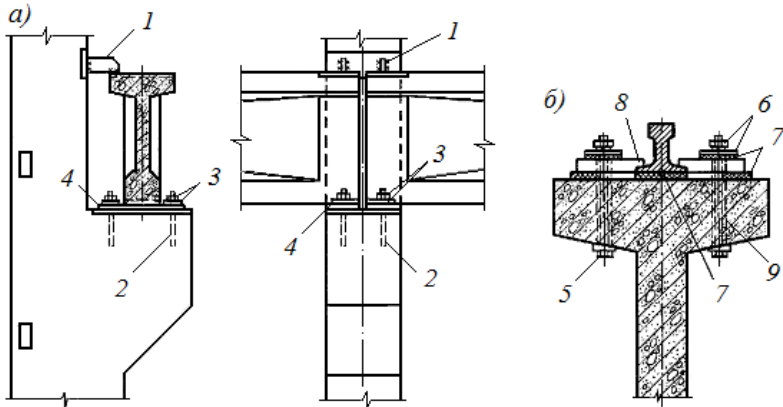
Вузли кріплення залізобетонних підкранових балок: *а* – до колон; *б* – кріплення кранової рейки; 1 – сталеві планки; 2 – анкерні болти («шпильки»); 3 – гайки з шайбами; 4 – опорні листи; 5 – болти; 6 – контргайки з шайбами; 7 – пружні прокладки; 8 – сталеві лапки; 9 – сталеві трубки
